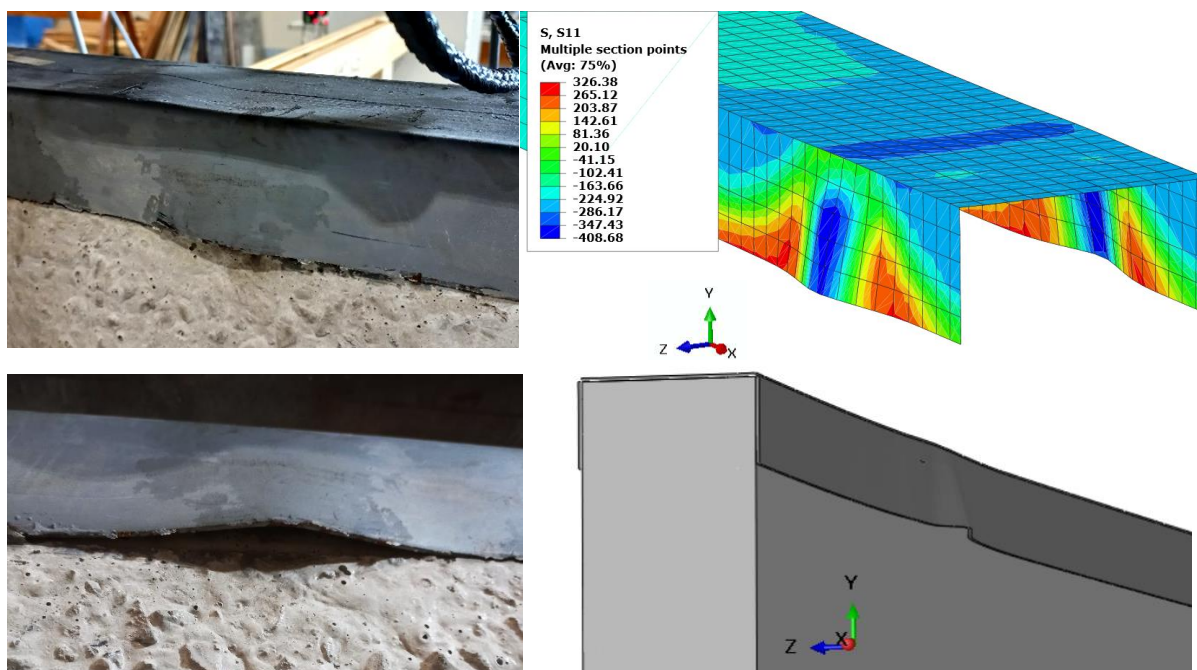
Padrão de fissuração da viga envelopada de concreto nos modelos experimental e numérico.
